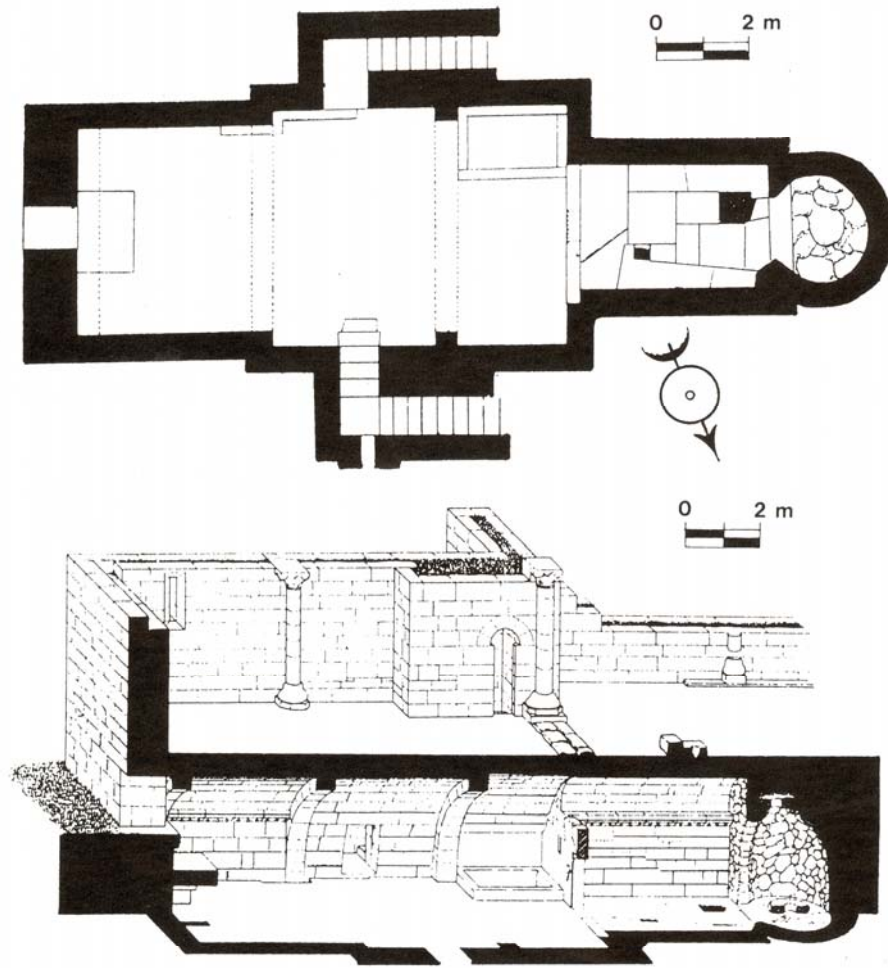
Planta y alzado del monumento de Augas Santas (Lorenzo Fernández, 1948).
